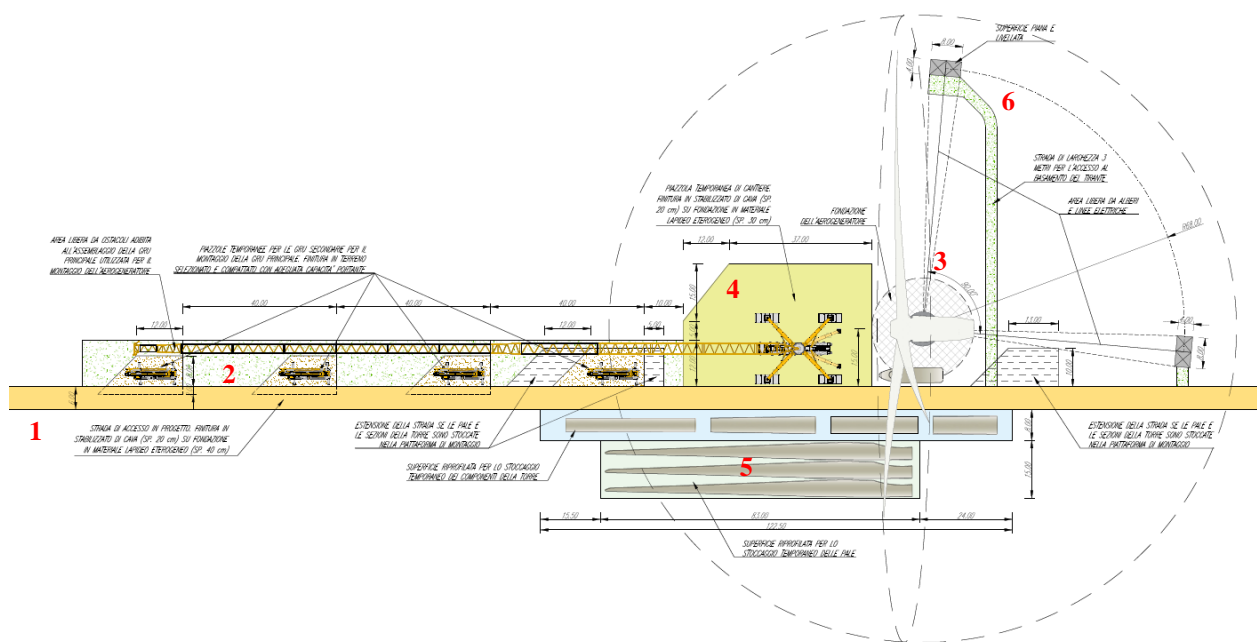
Piazzola di montaggio; 1. Strada di accesso; 2. Blocchi ausiliari; 3. Area di assemblaggio della torre; 4. Area di lavoro gru principale; 5. Area di stoccaggio; 6. Blocchi di ancoraggio - controvento.
